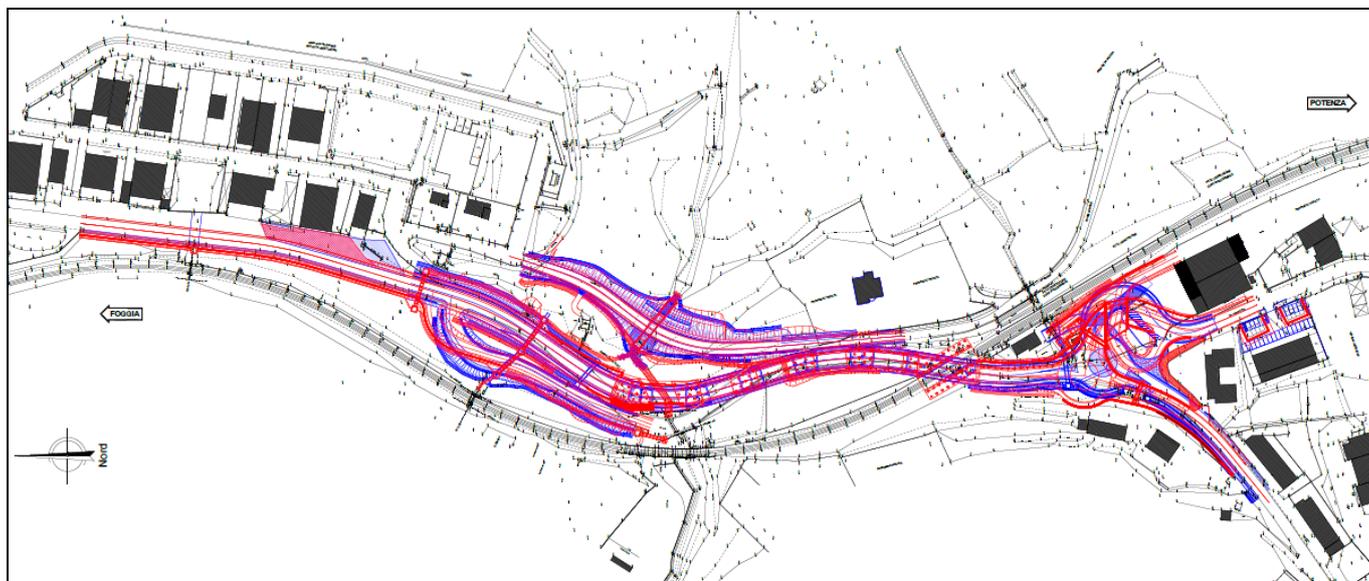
Confronto planimetriche di progetto PE (rosso) e PD (blu)
